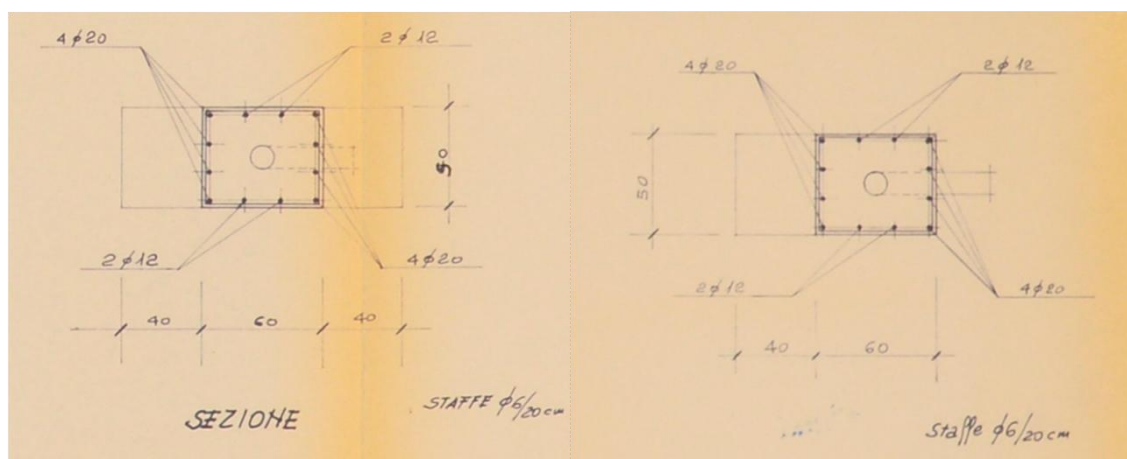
Particolare di A.1980.cap.us.T05 - Dettagli armature pilastri – Armature pilastri a doppia mensola (sx) e mensola singola (dx)
